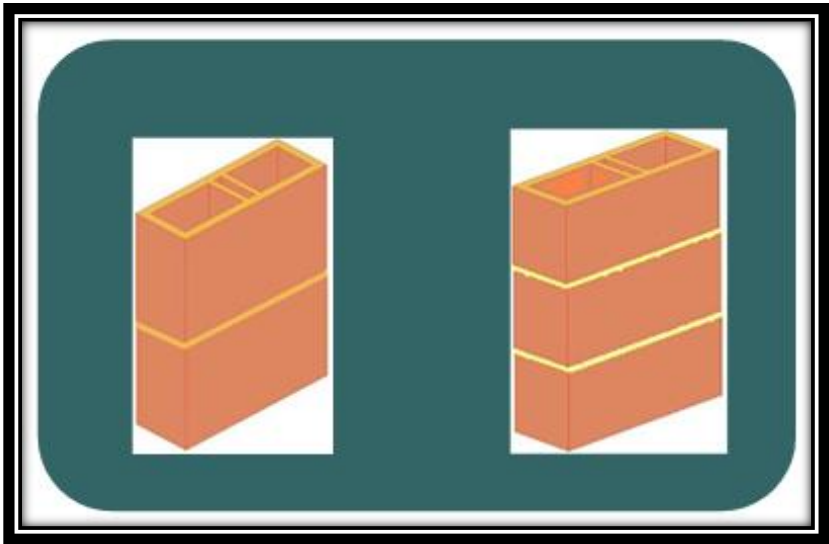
Detalle de elaboración de muretes para ensayo de Groutung.
